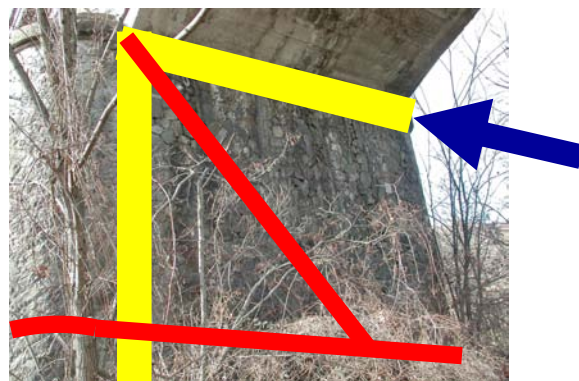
e. Intervento alternativo: due diagonali in composito incollati obliquamente alle pile, in luogo dei pali. L'azione sismica orizzontale è assorbita dal diagonale in FRP teso (linea solida più sottile), e dalla biella muraria verticale (linea solida forte). Questa soluzione è più economica, ma deturpa l'estetica dell'opera.
